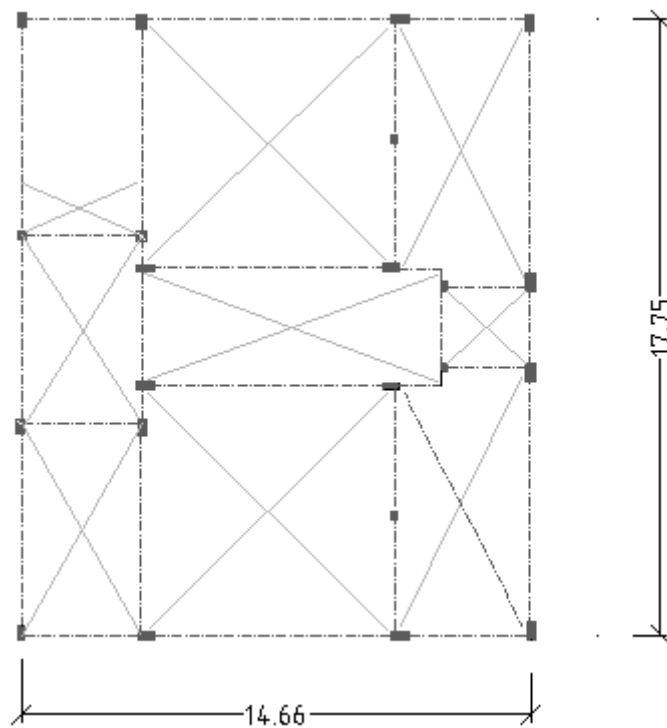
Planta do piso 2 (primeiro andar). (Adaptado de [Nível, C.; 2009])
